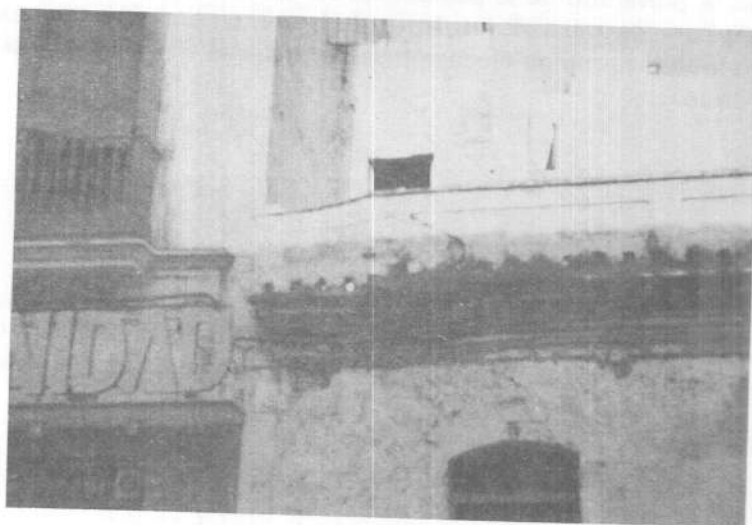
Casa baja cimentada en IV<sub>5</sub>, agrietada por la influencia de una edificación más alta
